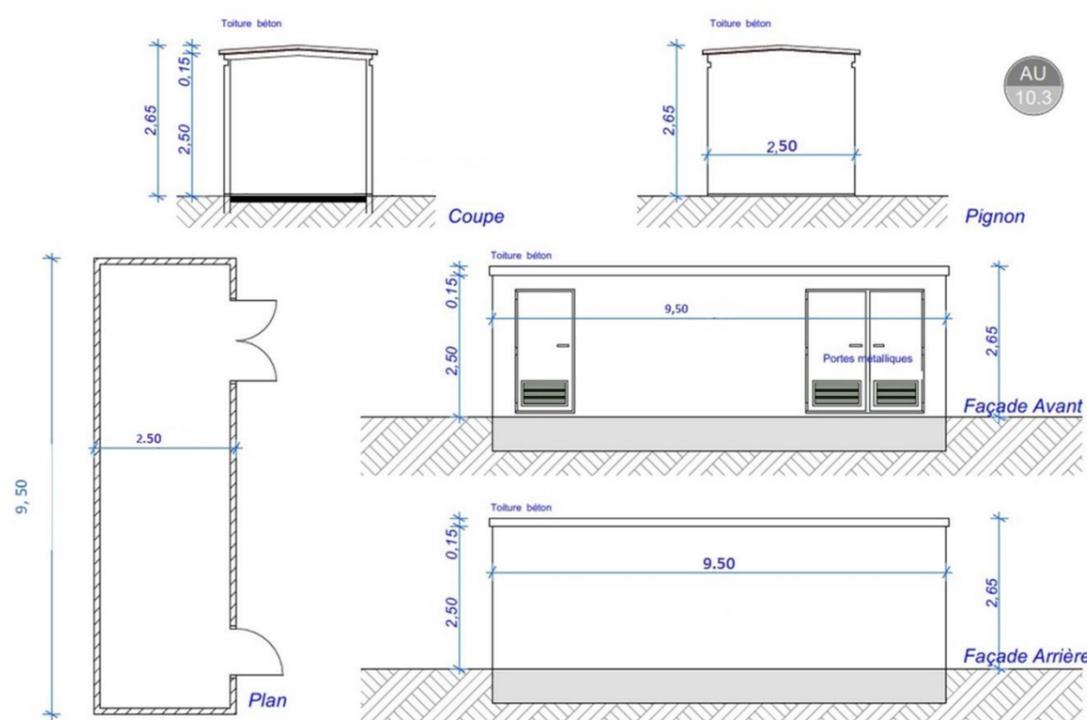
Plans d'un poste de livraison (source : Gamesa, 2016)
